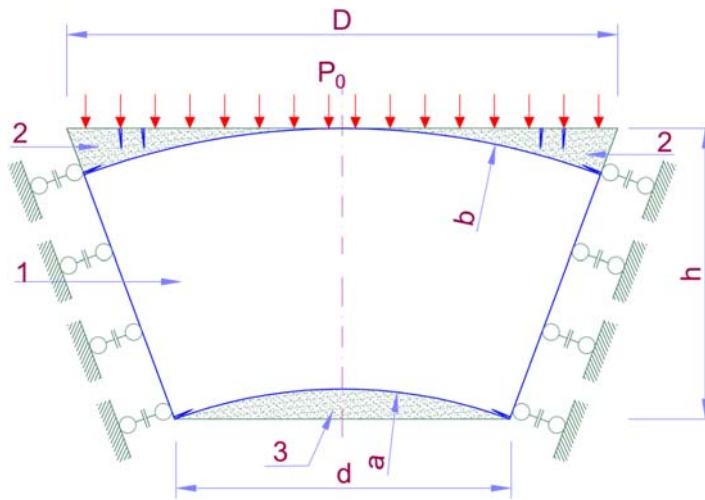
Формирование толстого сферического свода при плоском деформированном состоянии: 1 — толстая бетонная плита; 2 — растянутая зона, где происходит трещинообразование; 3 — участок, который не учитывается в расчете
